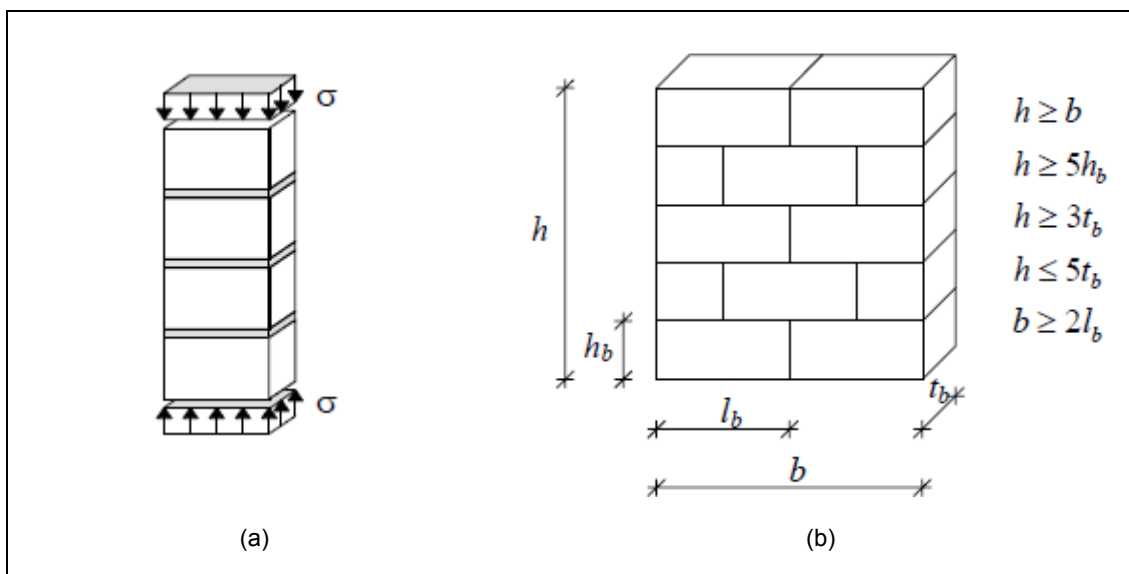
Ensaio utilizado para a caracterização da alvenaria à compressão; a) Stacked Bond Prism; b) ensaio RILEM, adaptado de (Lourenço, P. 1998)
